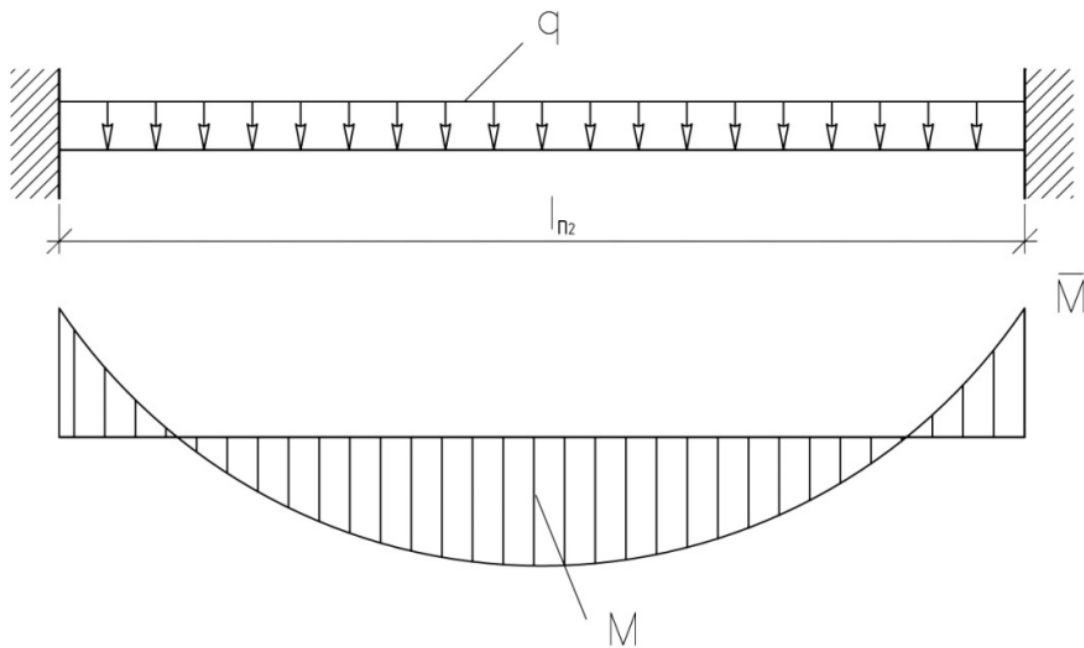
До розрахунку сходової клітки плити: конструктивна схема плити перекриття
